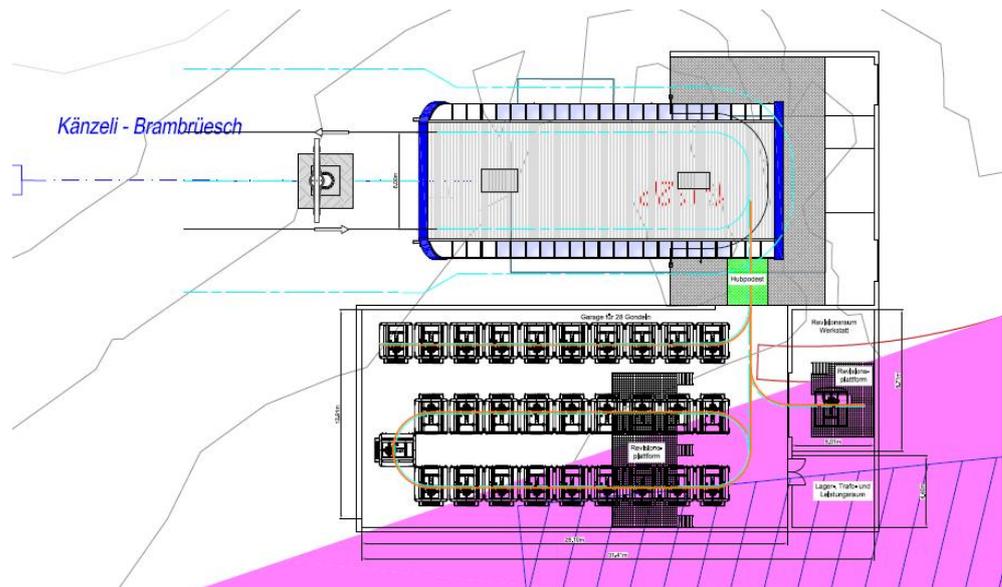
Möglicher Grundriss Bergstation Brambrüesch
